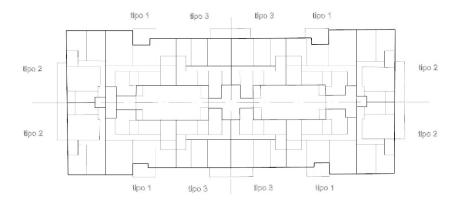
Distribución de tipos de viviendas en las plantas 1º a 3º. 2014. Propia.
